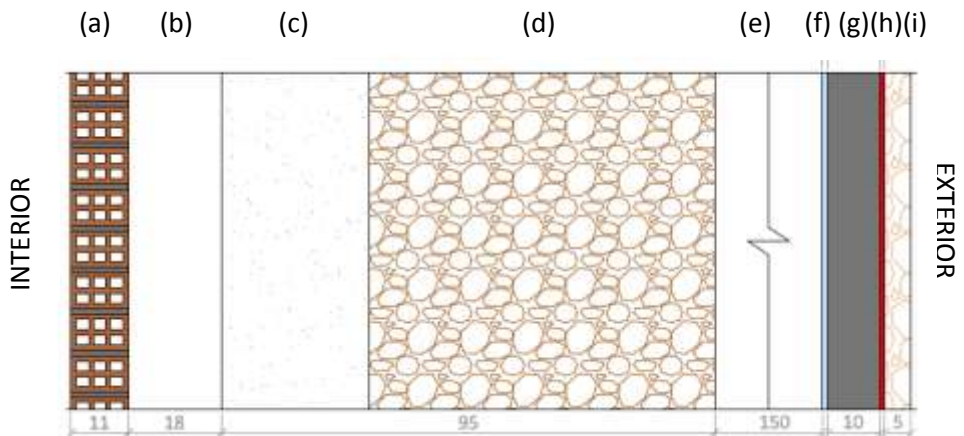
Esquema de las distintas capas del cerramiento de la fachada norte
